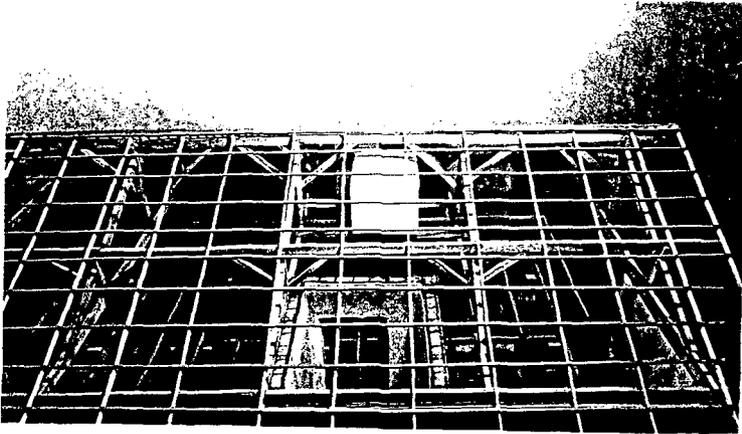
Vista da caixa d'água apoiada entre duas tesouras.
